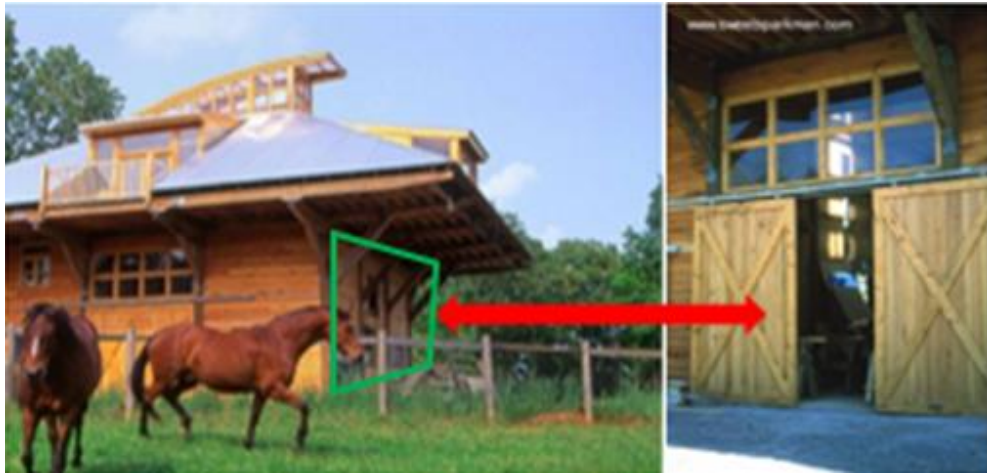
Acceso exterior e interior proyecto casa granero americano Bolt Barn
